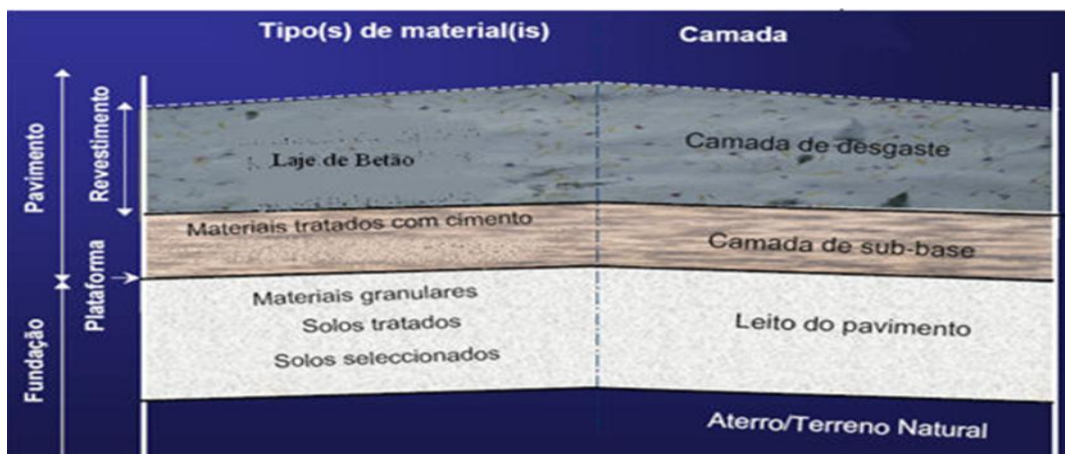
Estrutura de um pavimento rígido. (REIS, 2009).
